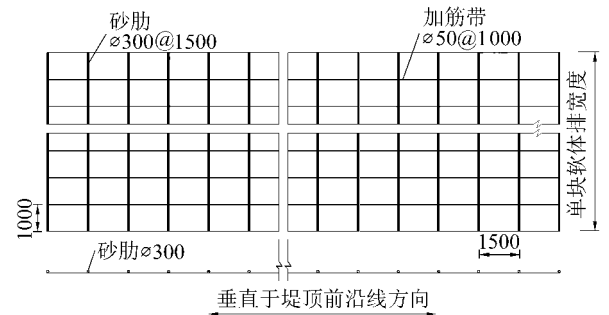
砂肋软体排结构加工平面示意图(单位: mm)
